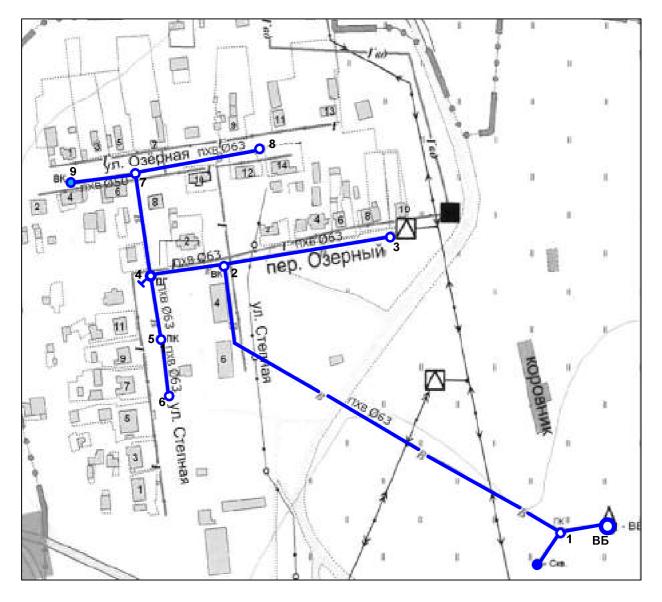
План водопроводных сетей с. Трофимовка
